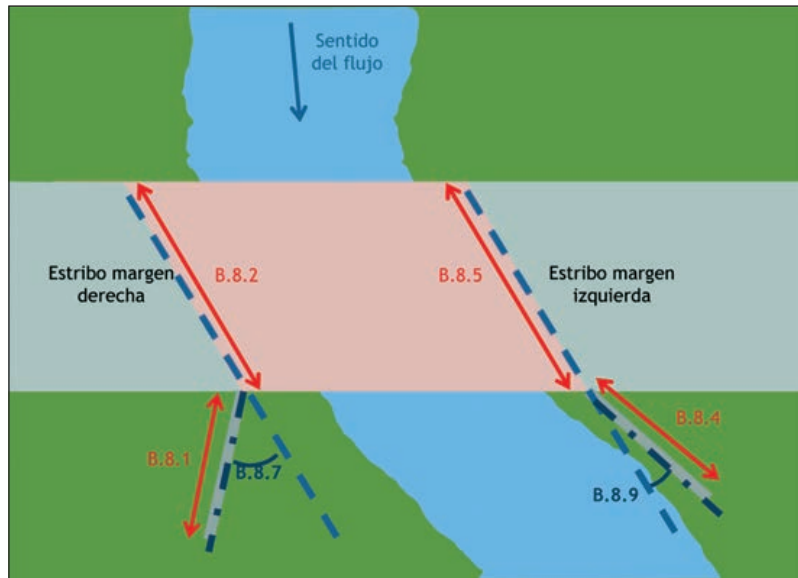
ANCHURA DEL PARAMENTO DE LOS ESTRIBOS DE UN PUNTE.
